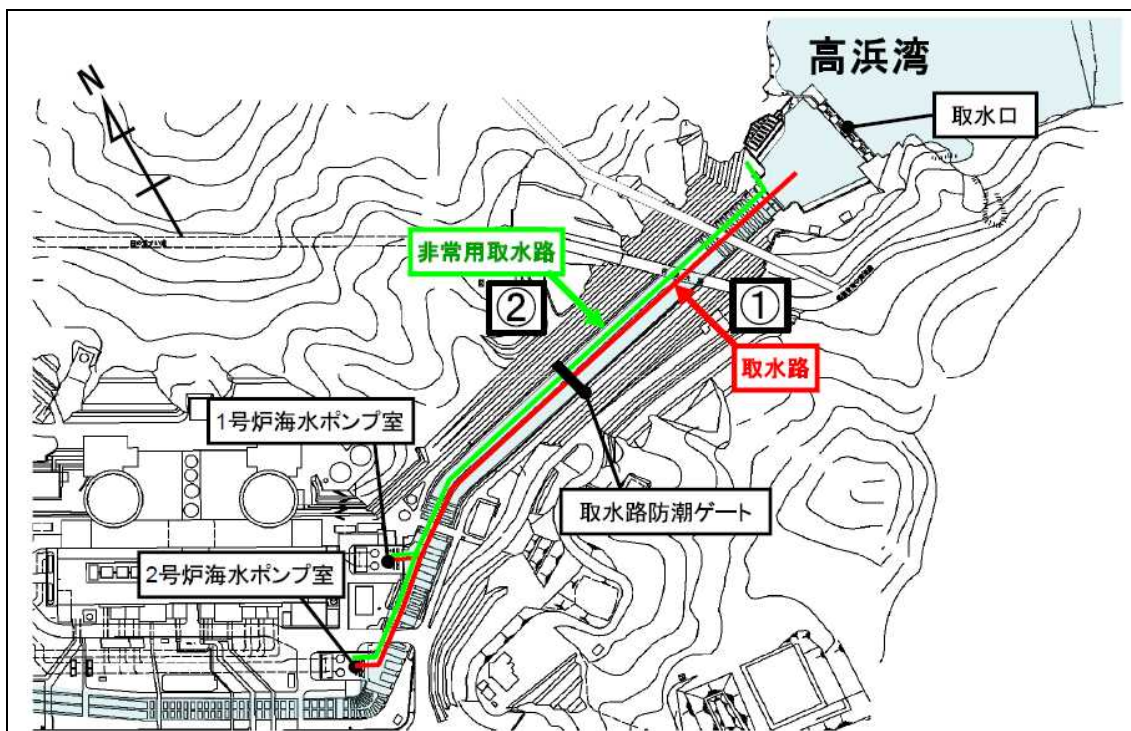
1, 2 号炉海水取水系配置図（取水路防潮ゲートの配置）
